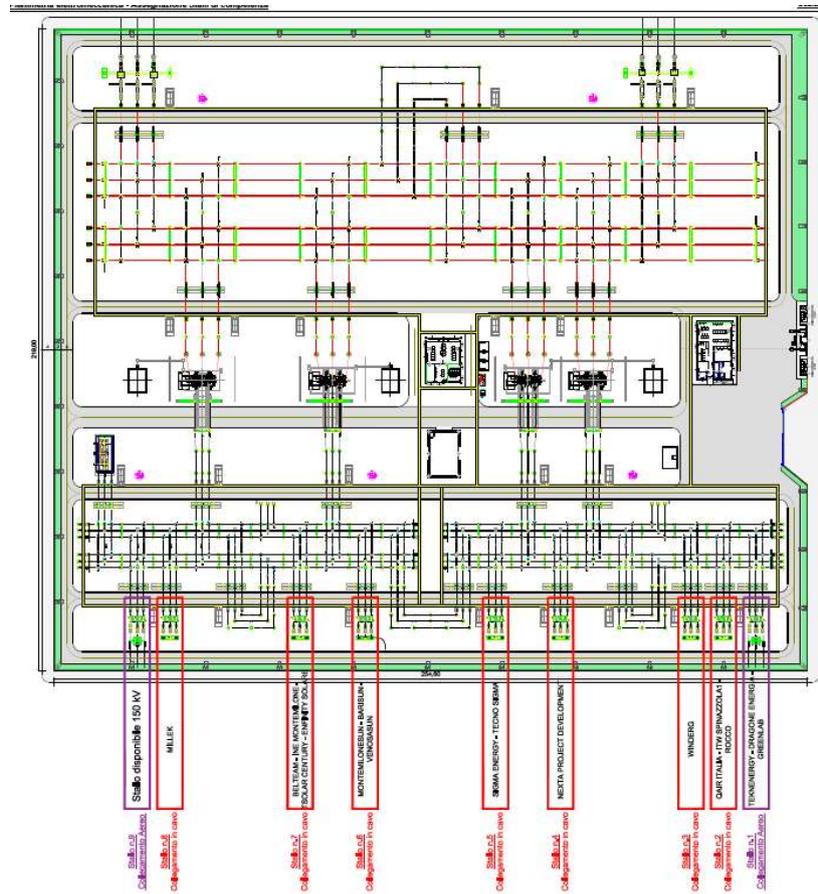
Planimetria SE con ubicazione dell'assegnazione degli stalli
